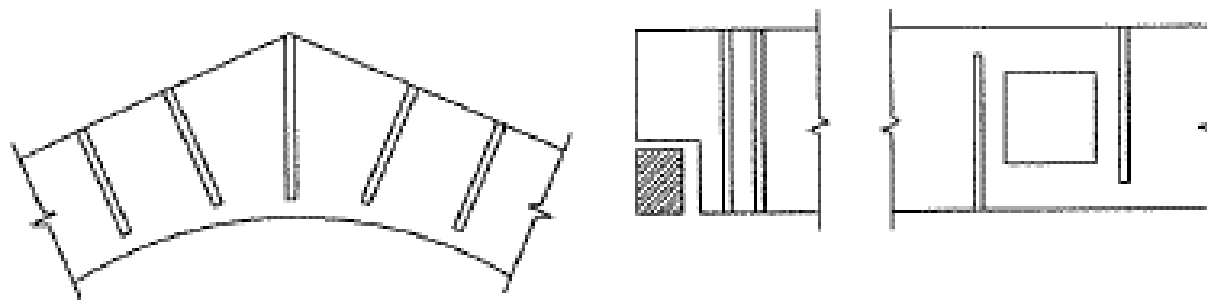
Barras encoladas como armadura frente a la tracción perpendicular.
